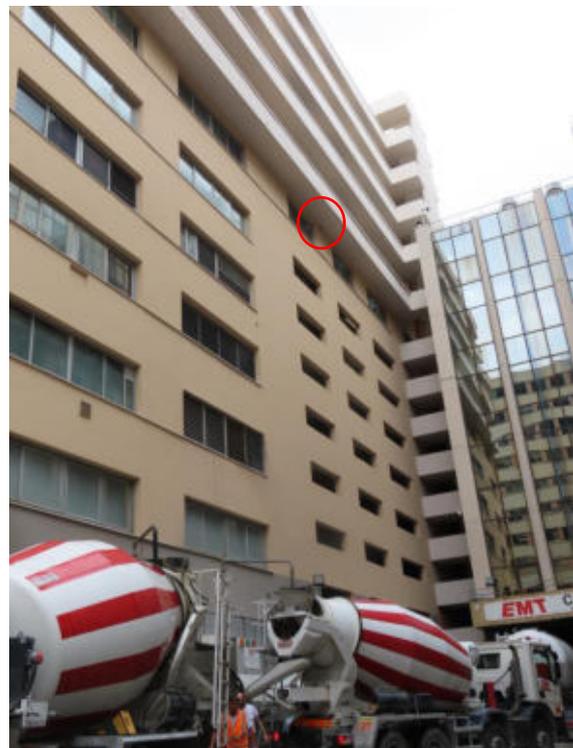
Fontvieille, rue du Gabian EMT, Centrale à béton, sous 1er balcon blanc © G. Beaudoin - CEN PACA
